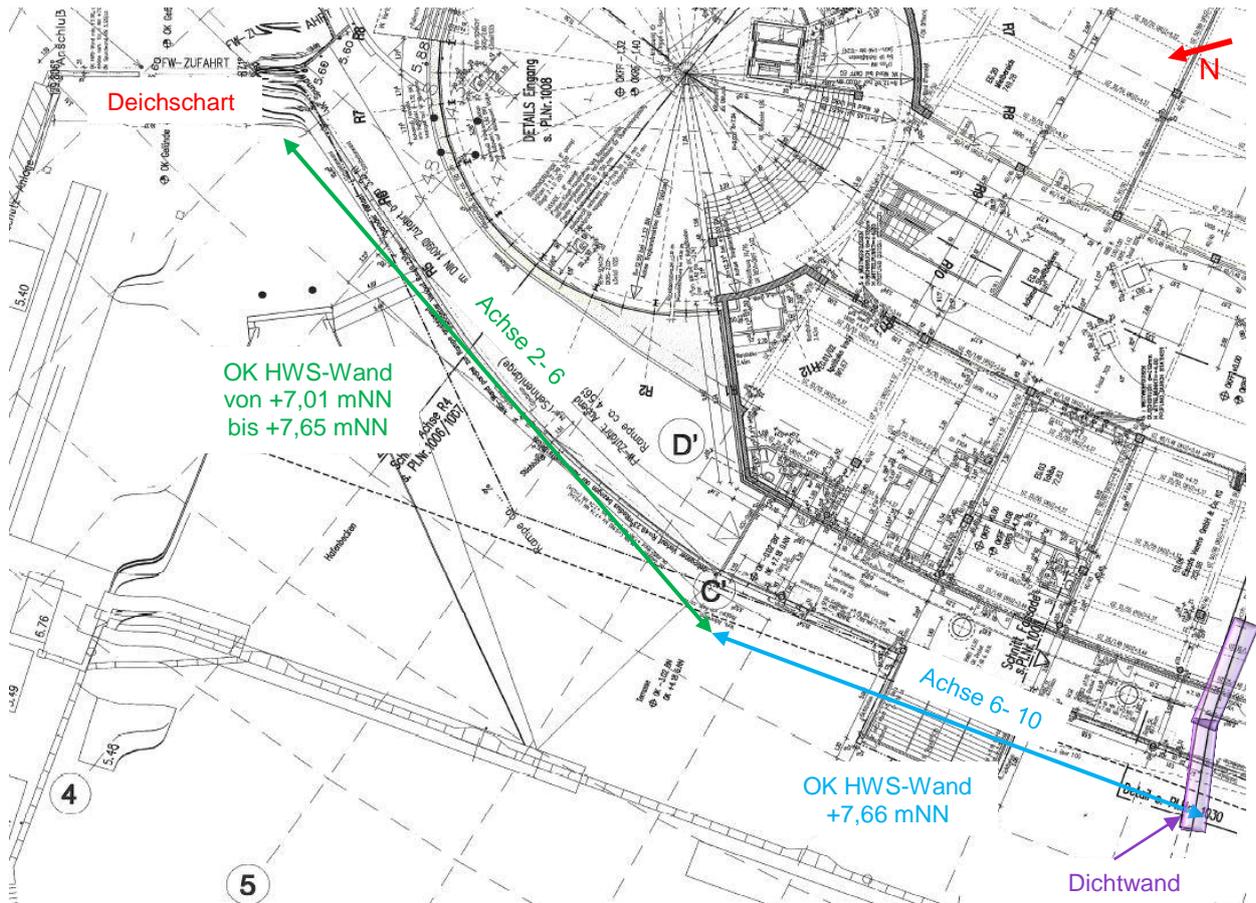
Öffentliche HWS-Wand – Ausschnitt aus dem Plan 101 (Stand: 13.02.2001)
